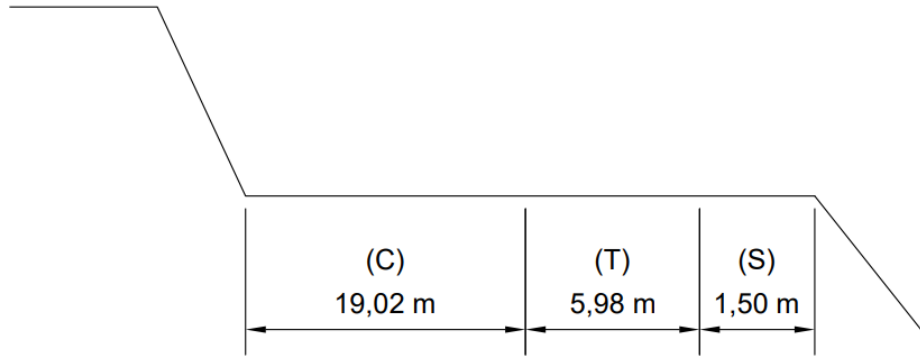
Perfil de la anchura de la plataforma de trabajo.
